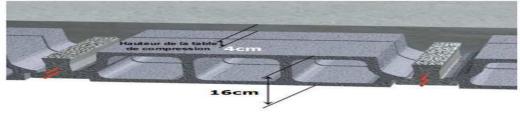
Schéma explicatif d'u plancher à corps creux.
